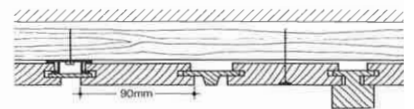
Planches acoustiques (selon DIN 68127) avec ressort simple ou baguette profilée. Fixation visible, par boulons ou clous, ou par agrafes invisibles. Autres possibilités: planches chanfreinées à rainure et languette, frisettes (voir p. 20).
